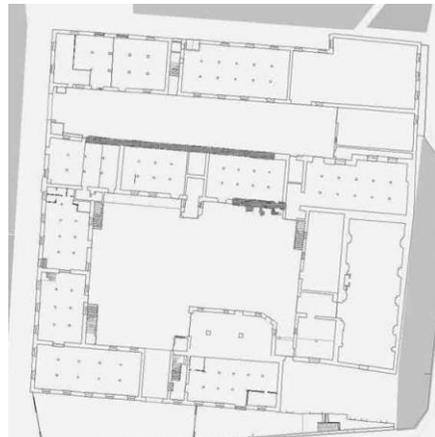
Casa de Hernando Colón - Planta baja (restos documentados del palacio).
